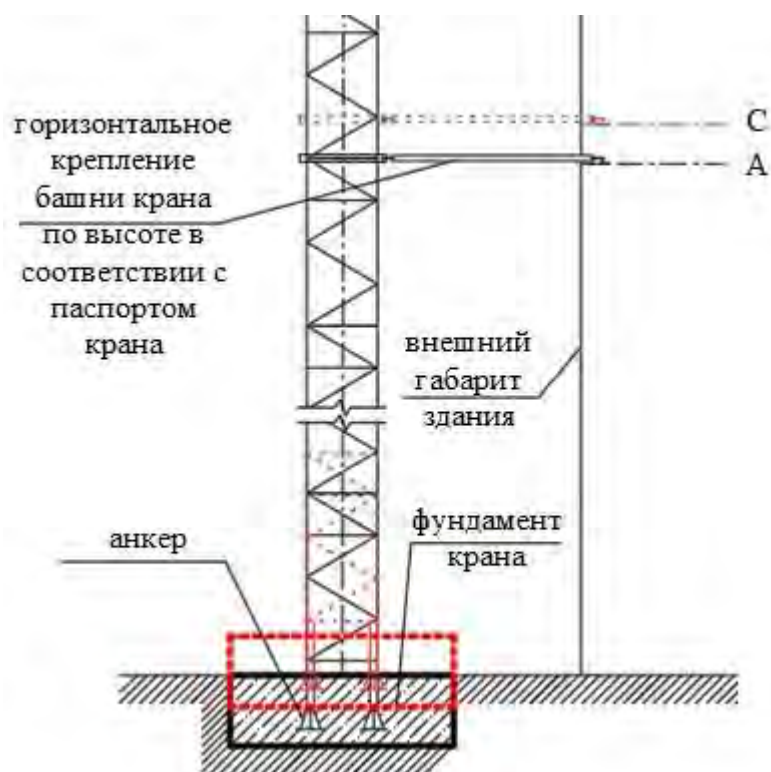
Условная схема горизонтального крепления стационарного башенного крана на фундаментной плите (вариант С)
